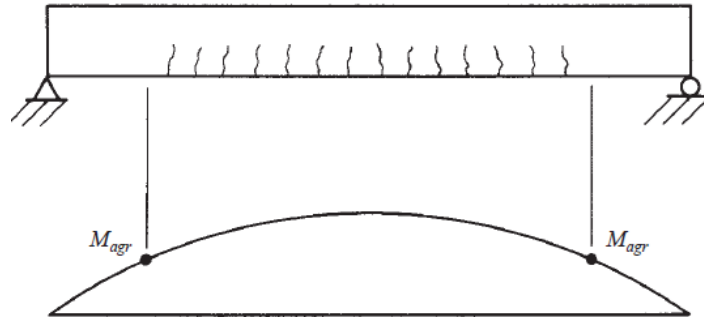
Grietas en zona de tensión del concreto. Fuente: McCormac y Brown, 2011.
